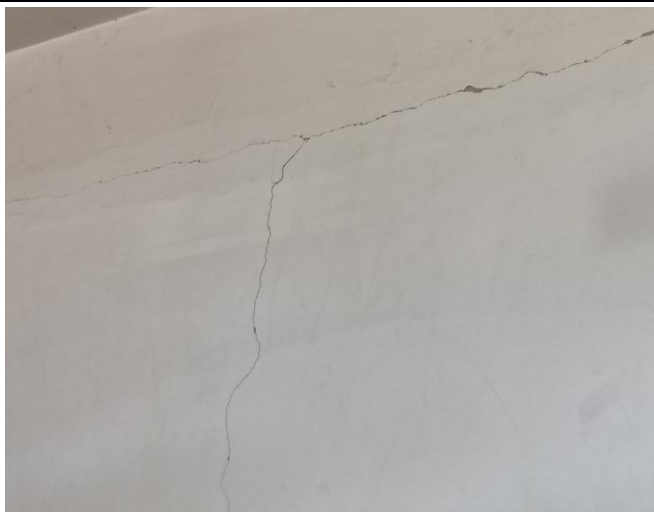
,68,69,70,71 et 72 : Apparition des fissures au niveau des enduits.
